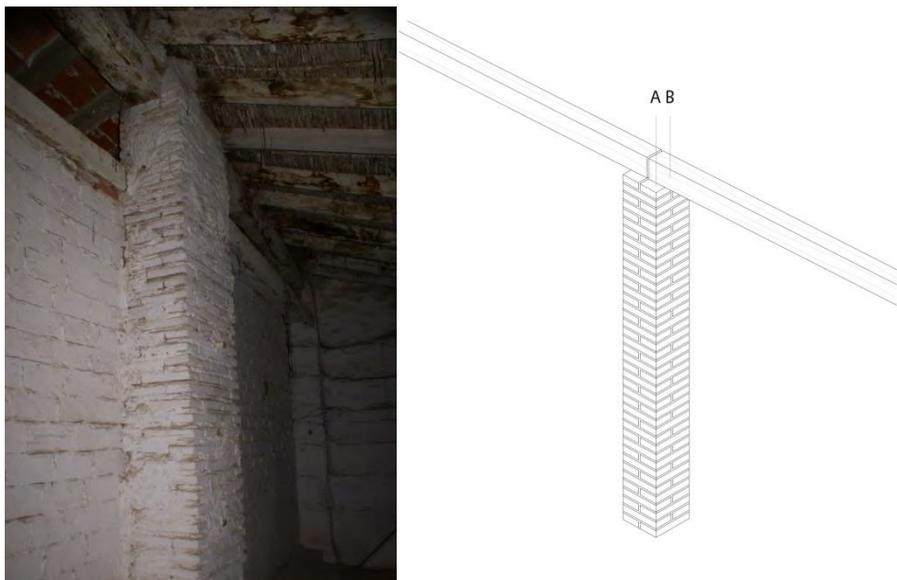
Vivienda en c/Mayor, 29. Pilar central de ladrillo en planta superior.
